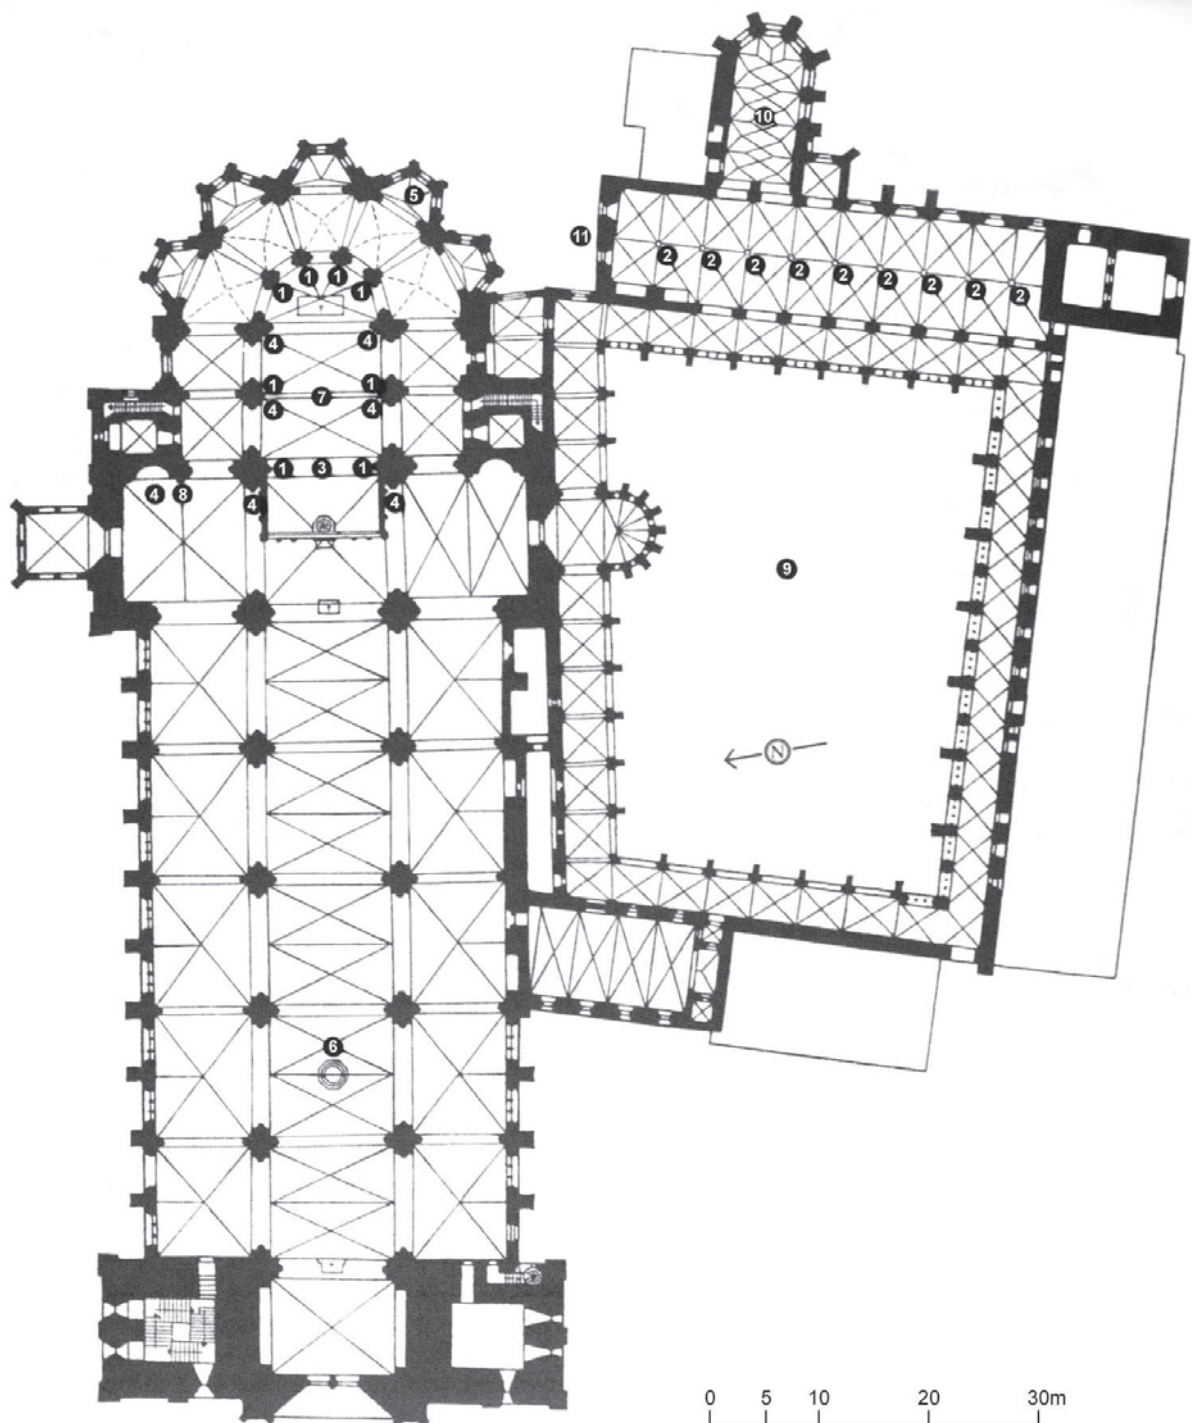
Magdeburg, Dom. Grundriss mit Eintragung der Spolien.
